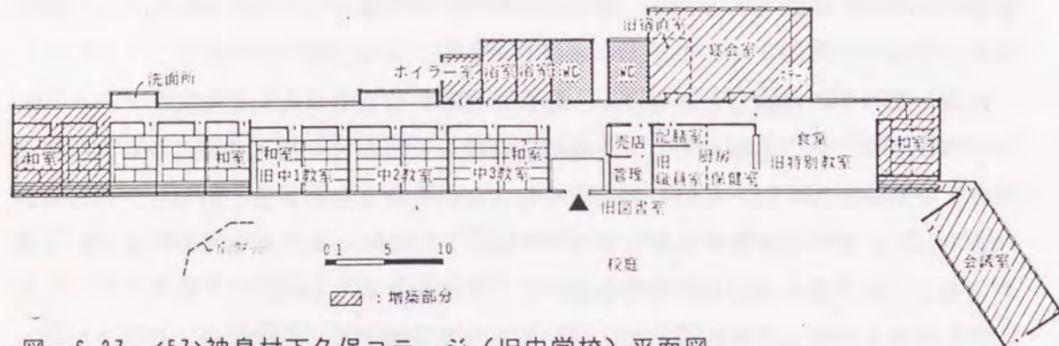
<57>神泉村下久保コテージ（旧中学校）平面図
